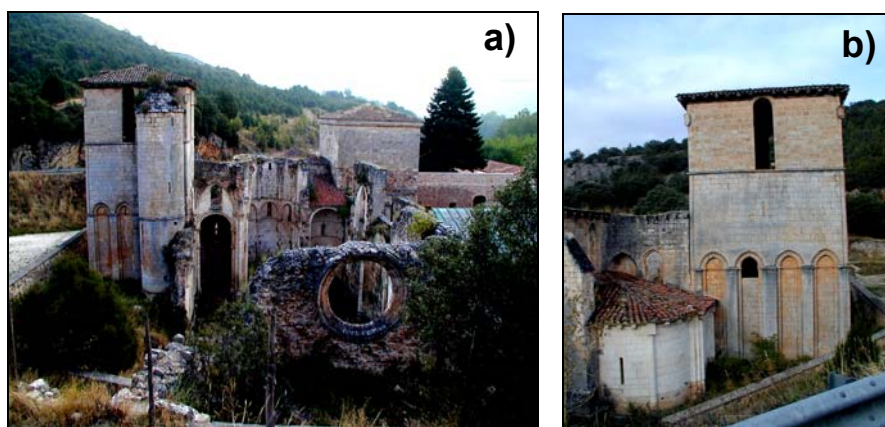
a) Vista sur del Monasterio de San Pedro de Arlanza. Se observa el estado de ruina y la ausencia de cubiertas; b) imagen en la que se aprecia un ábside restaurado.
